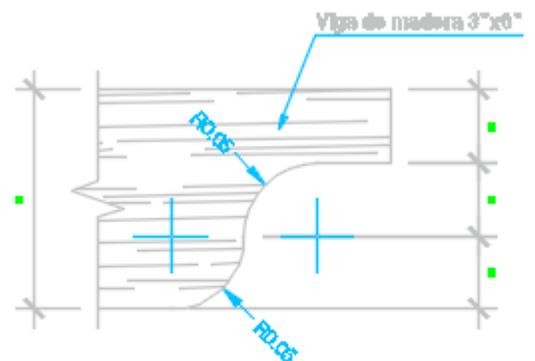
Detalle 1 columna en madera, elaboración propia
